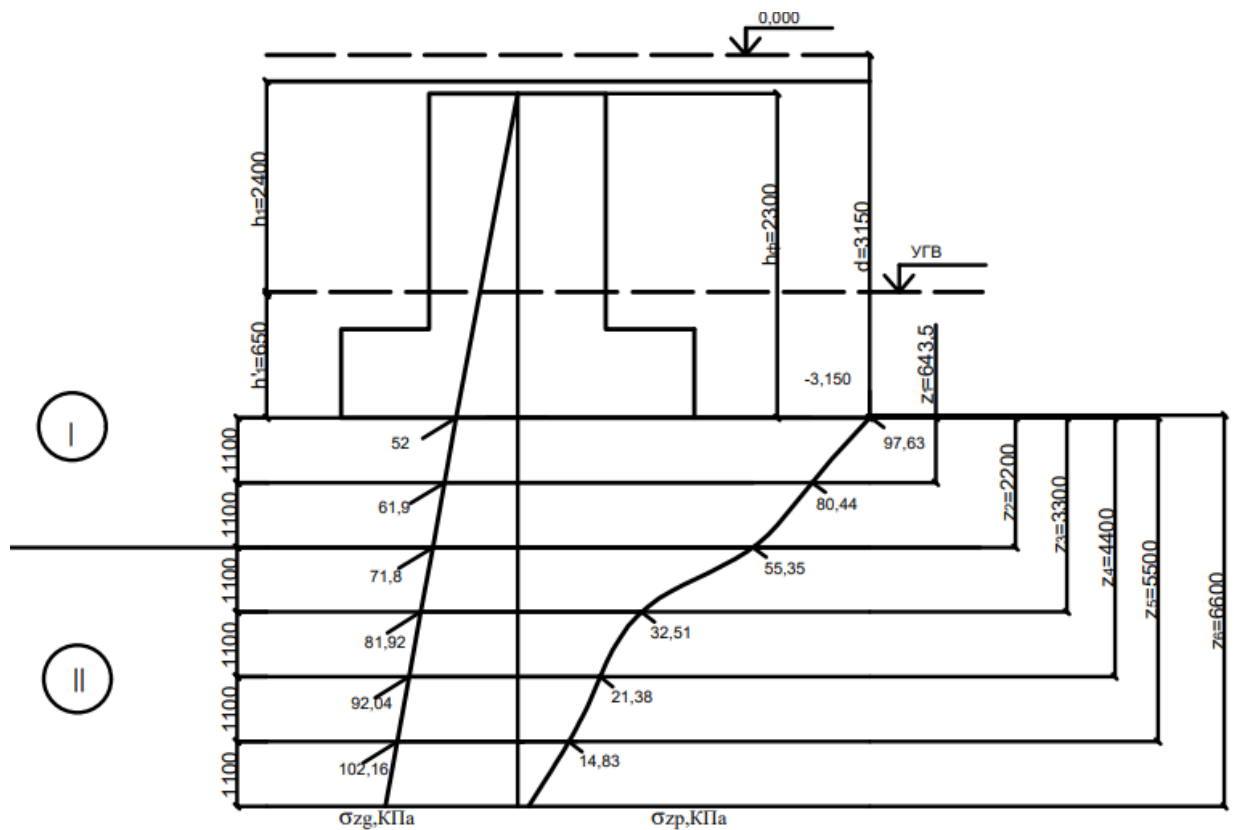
Расчетная схема к определению абсолютной осадки фундамента
